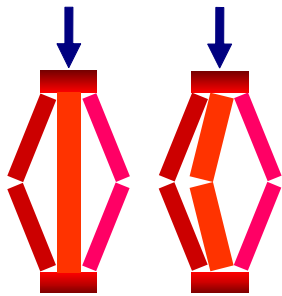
Collasso di un elemento murario verticale non-rinforzato.
